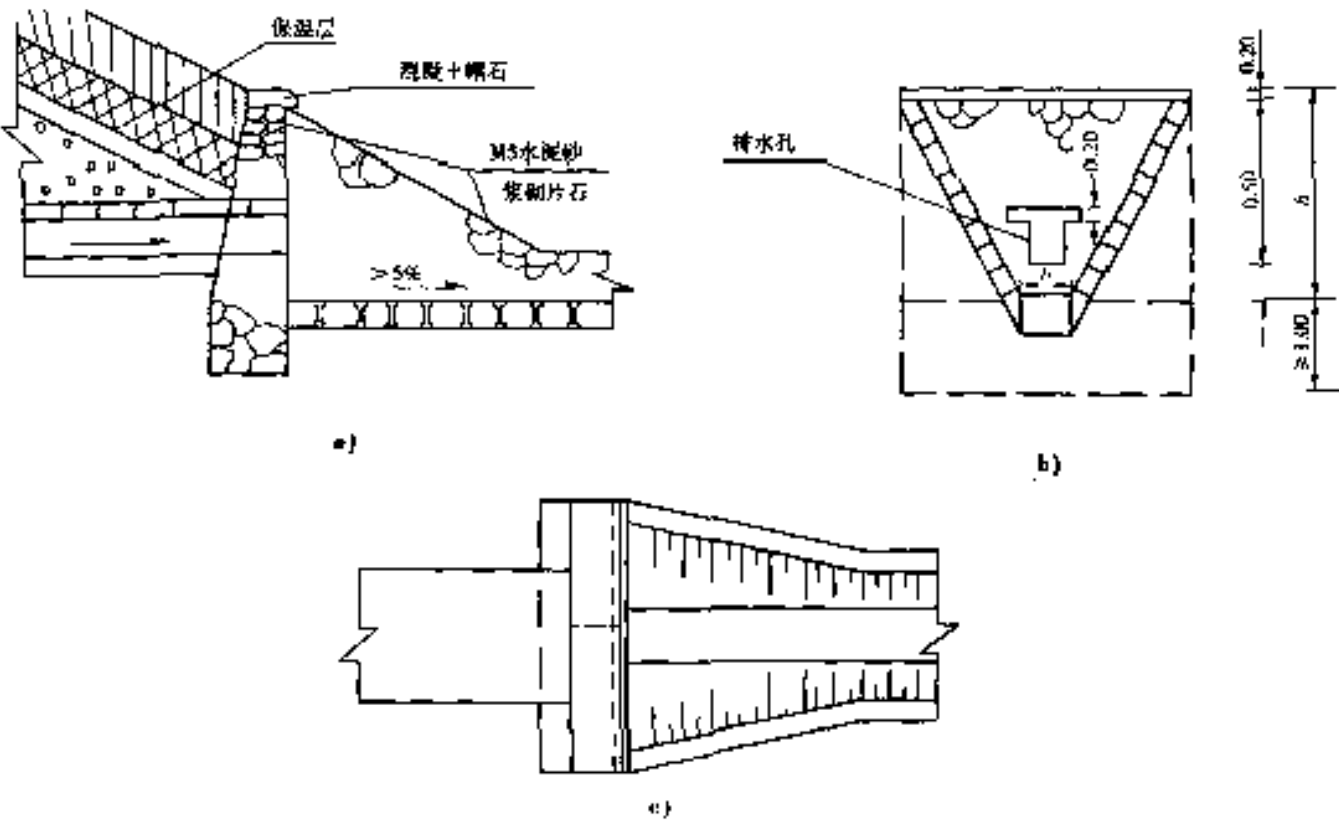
砌墙式保水出水口示意图(尺寸单位:m)
